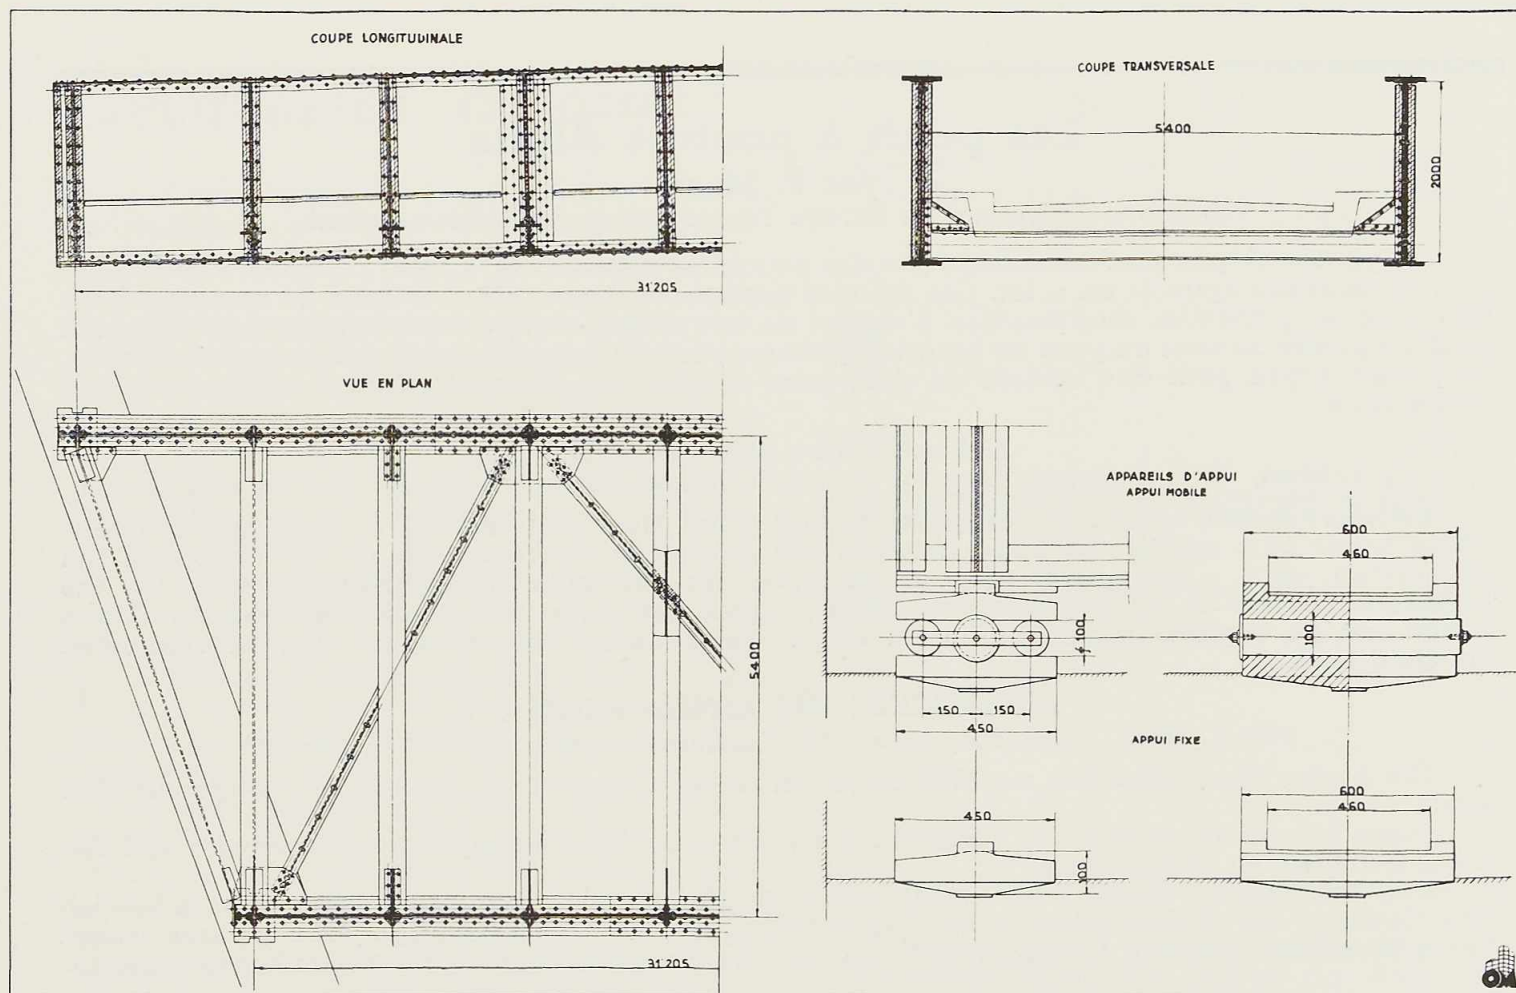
Coupes longitudinale et transversale, vue en plan et détails des appuis du pont sur le torrent Cismon.
